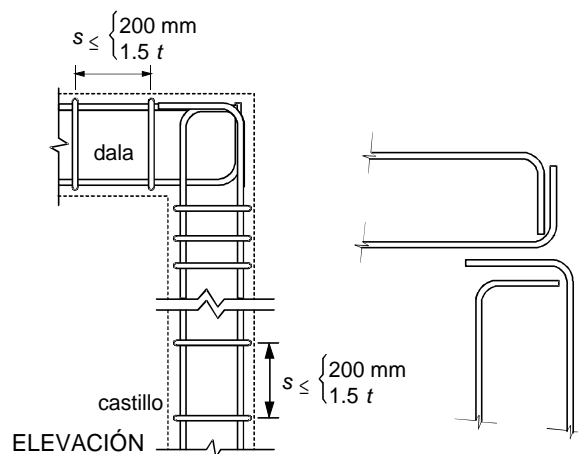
Algunos detalles de armado y anclaje de castillos y dalas (GDF, 2002)
